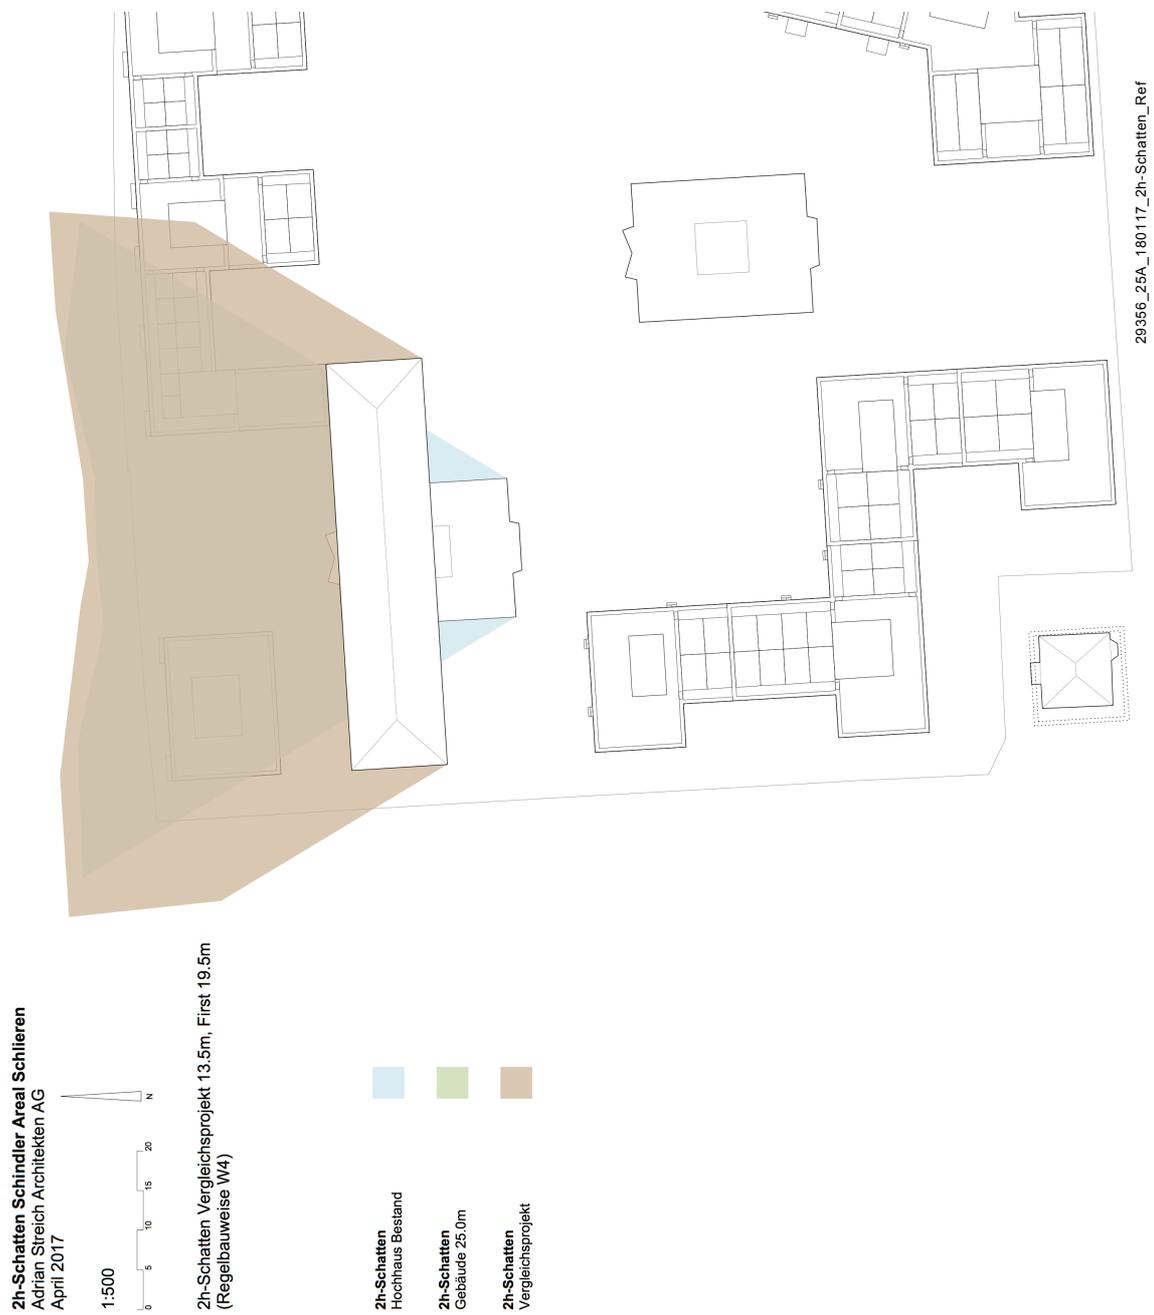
Plan des Zweistundenschattens des Hochhaus Nord und Vergleichsprojekt vom April 2017 (verkleinert)
